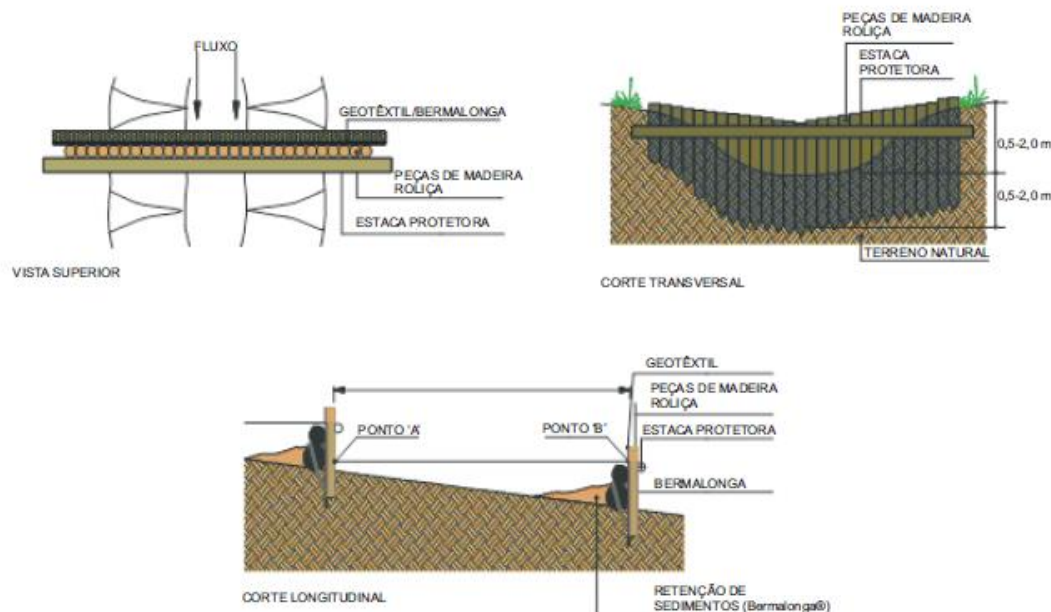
Modelo de visada em planta e corte da construção de paliçadas de madeira
